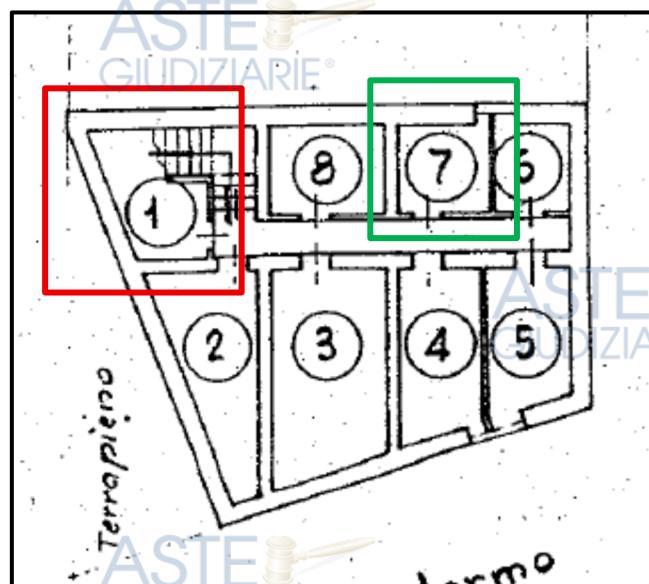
Fig. II – Estratto planimetria allegata a Regolamento di Condominio
